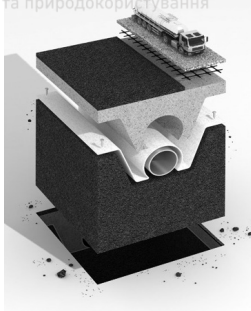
Схеми баластування трубопроводу ґрунтом з приміненням нетканних полотен (геотекстиль):
